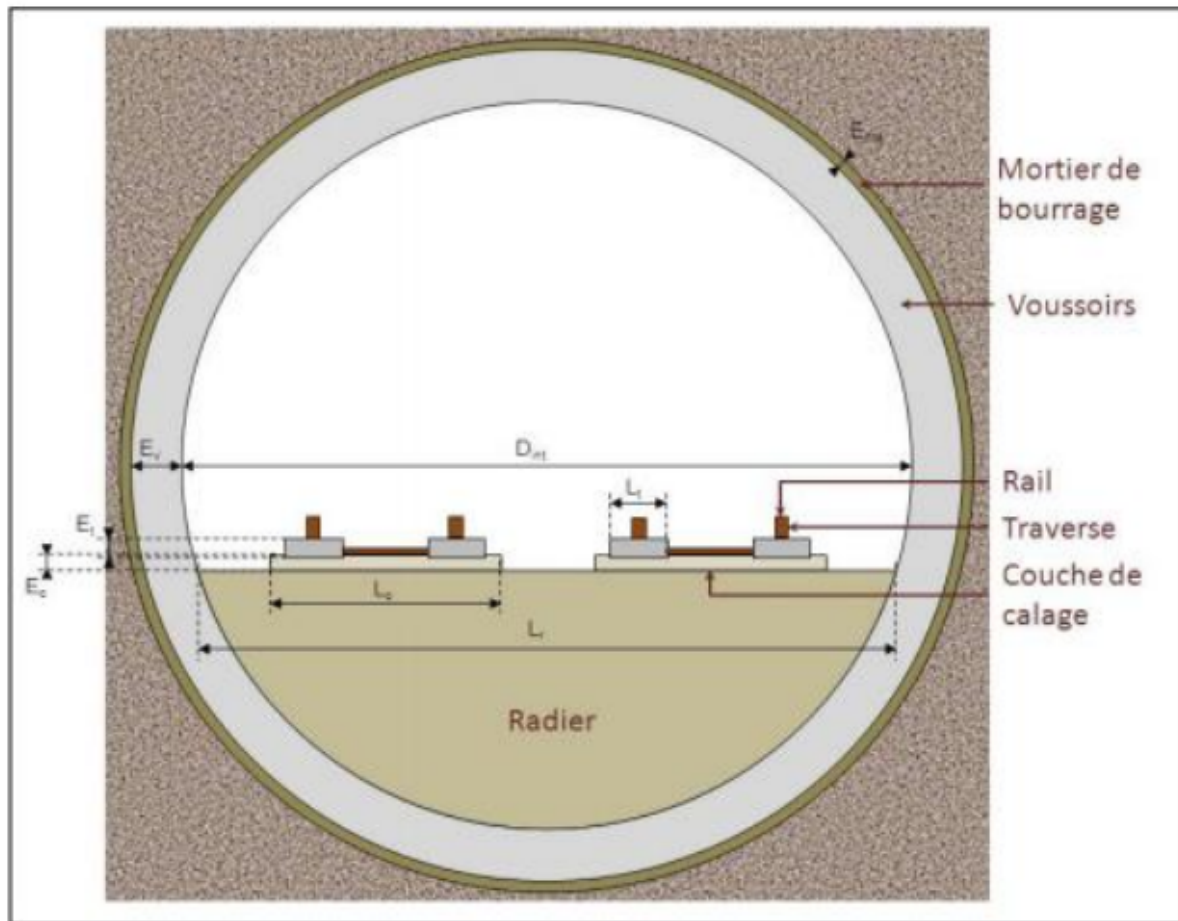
Tunnel – Schéma d'une vue en coupe et dimensions prises en compte dans l'outil
